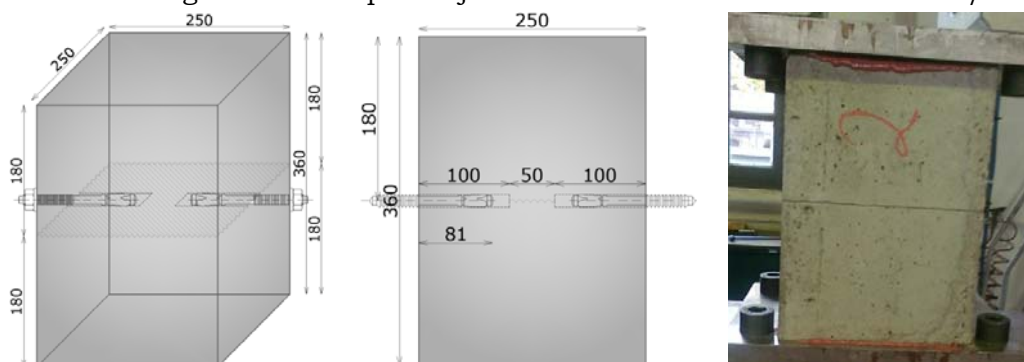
Gjeometria e kampioneve prej betoni të përdorur për provat.
